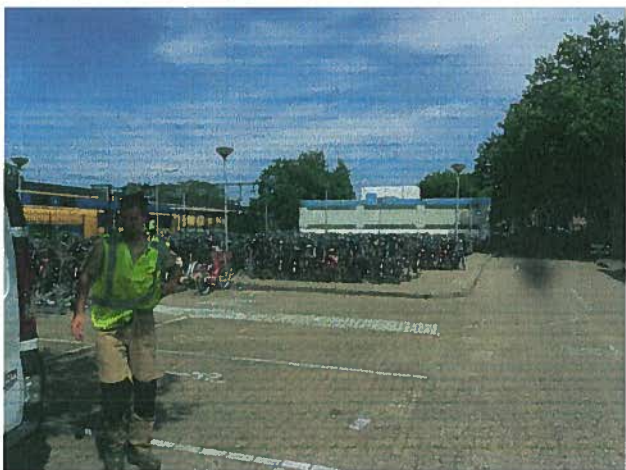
Overzicht locatie t.p.v. boringen 13 t/m 21
